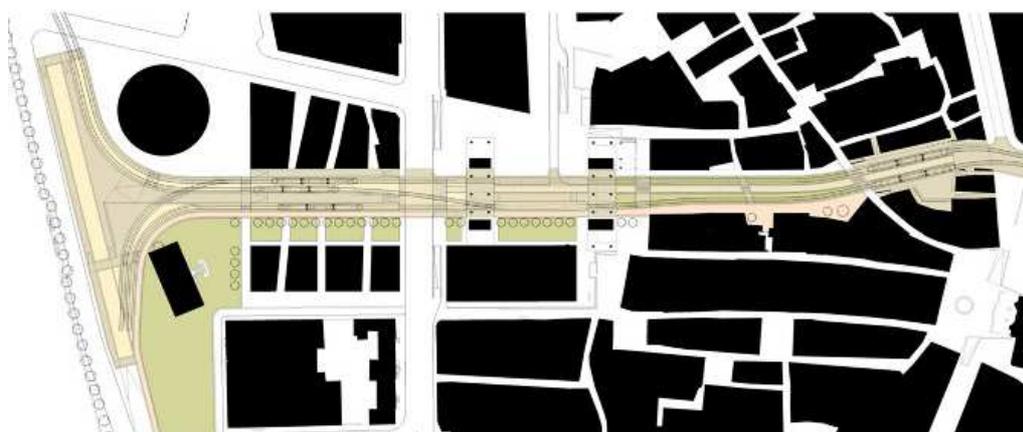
Canal Metro Mondego ou a designada “Via Central”.
